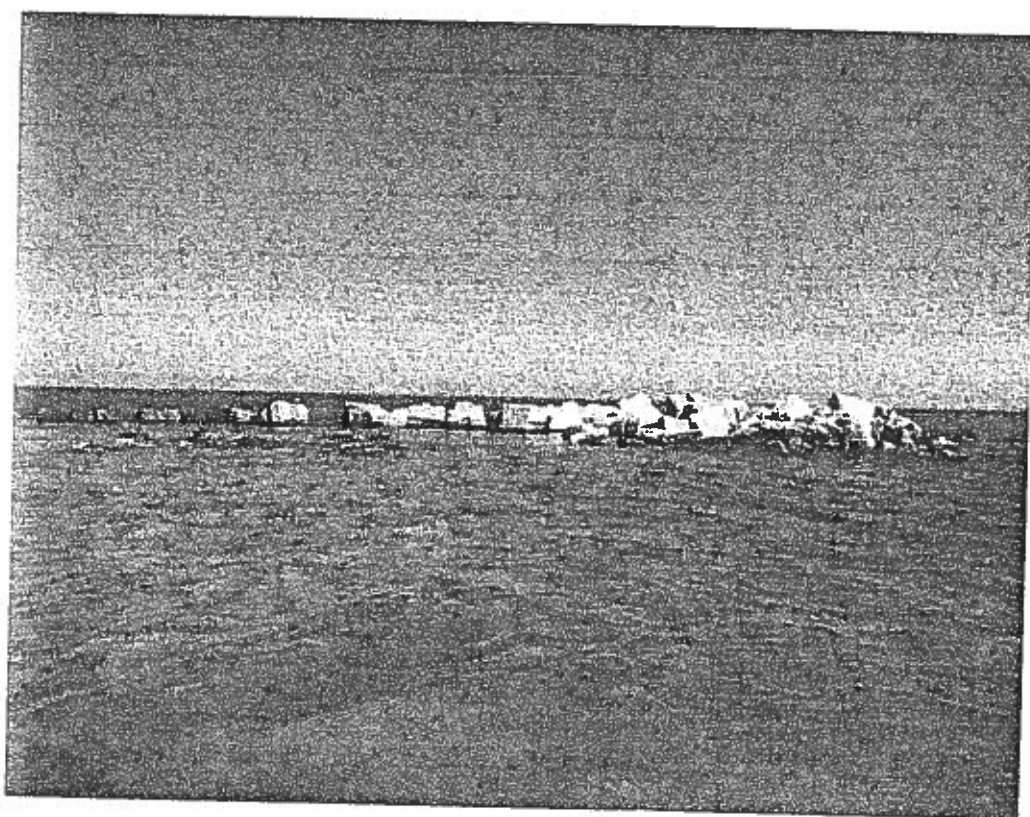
del 27.10.2017 – Lato terra e fondali del secondo braccio del molo di sopraflutto
